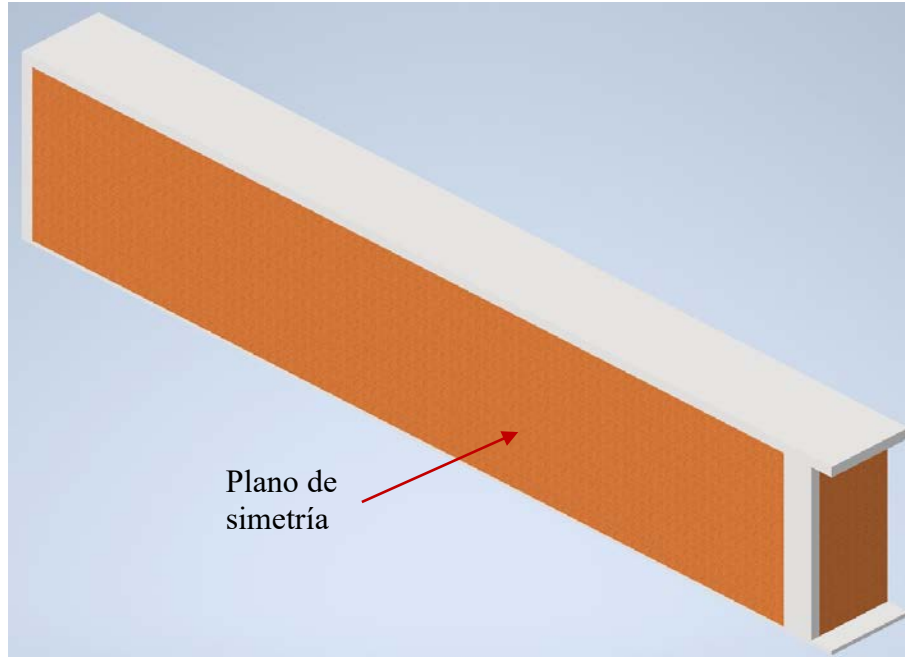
Representación del modelo original con un corte en el plano de simetría.
